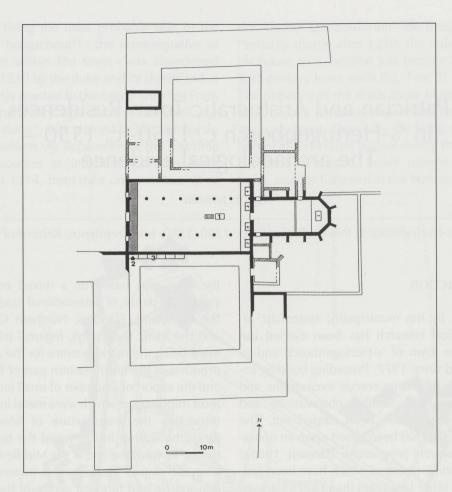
Königsfelden, Grundriss der ehem. Klosterkirche mit Lage der beiden Klaustra (nach Gerber 1986, mit Ergänzungen von CJ); gerastert = rekonstruierte Empore; 1 = Habsburgergruft; 2 = obergeschossiger Zugang zur Empore; 3 = Grabgrüfte mit vornehmlich weiblichen Skeletten.
